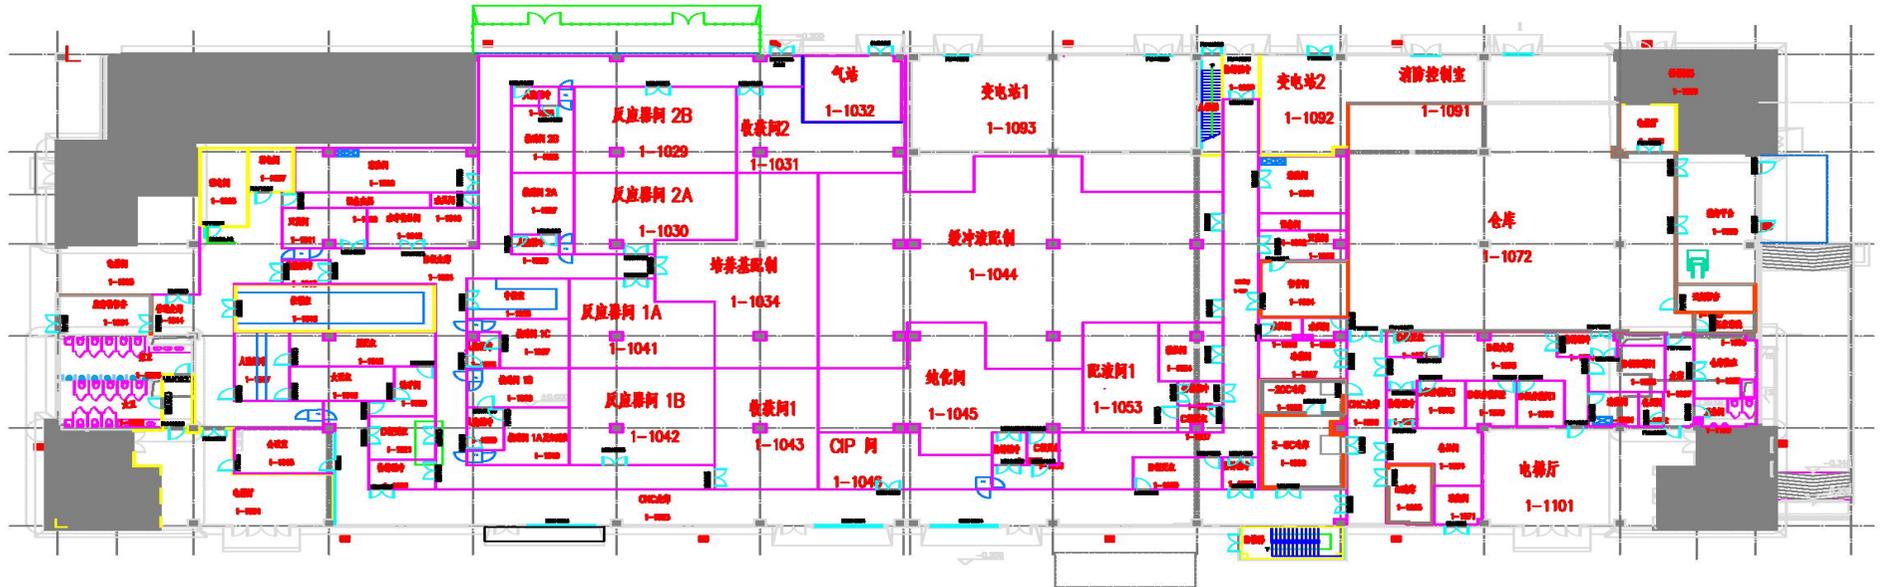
康日百奥生物科技（苏州）有限公司厂区平面布置示意图（一层）
